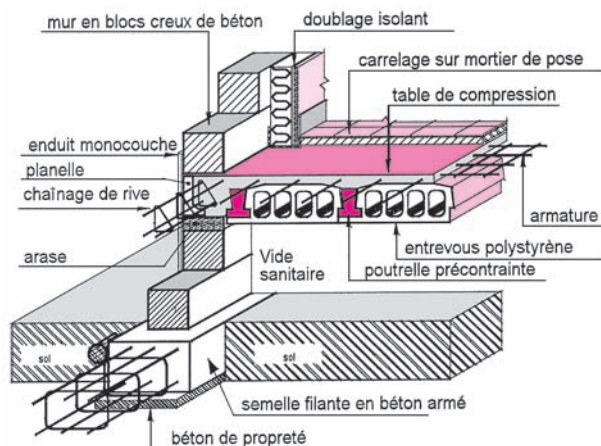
Visualisation : fondation, soubassement et plancher sur vide sanitaire
